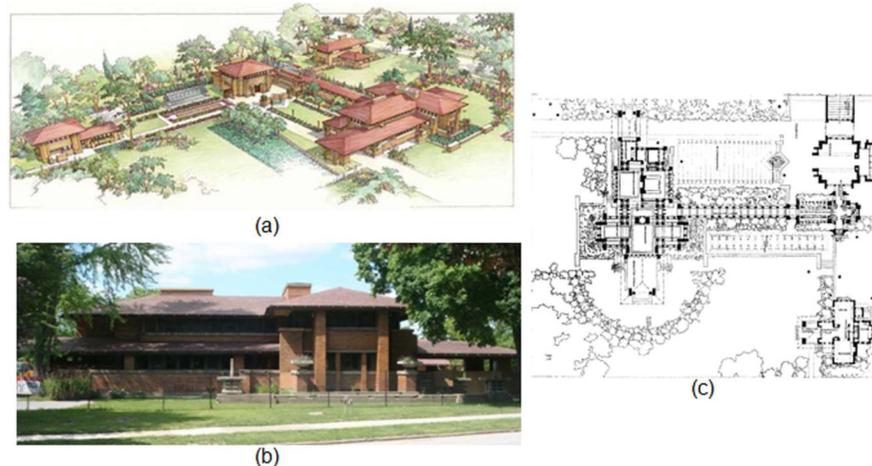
Frank Lloyd Wright, Casa Martin, Buffalo, Nueva York, E.U.A., (1904): (a) Vista aérea, (b) Fachada principal, (c) Planta arquitectónica, planta baja.
